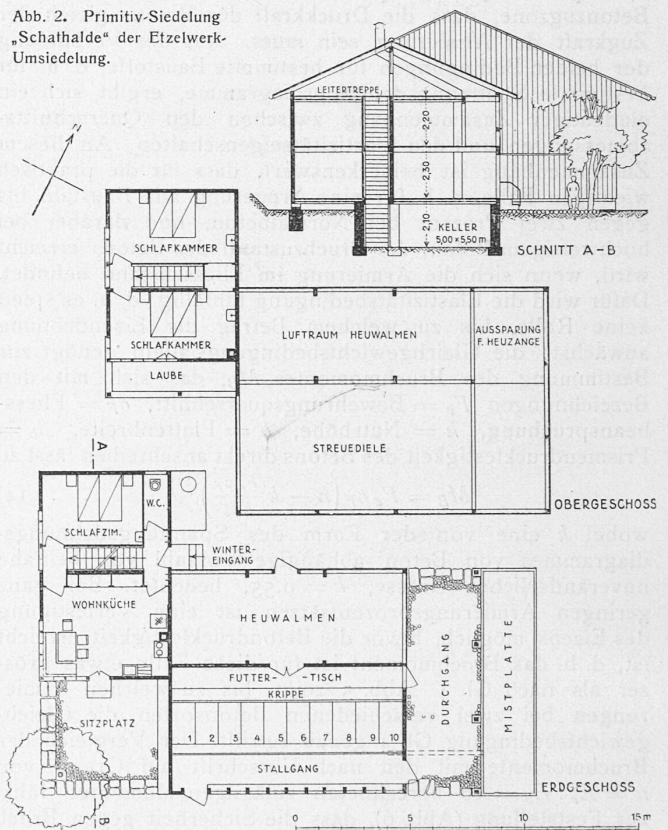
Schafhalde, Schnitt und Grundrisse 1 : 300.
